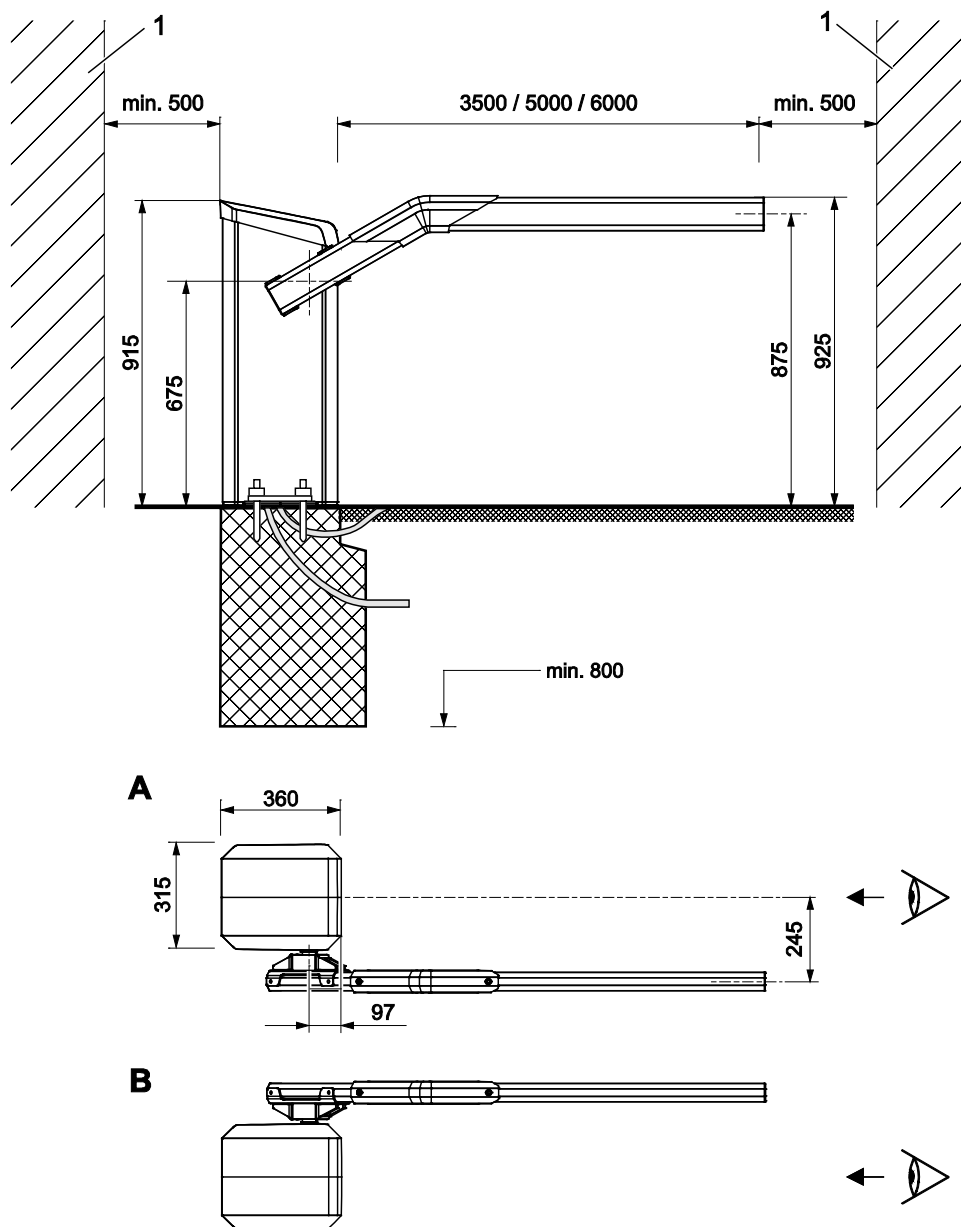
Abmessungen Schrankenanlage und Schrankenbaumprofil – Serie "Access" (Maße in mm)
